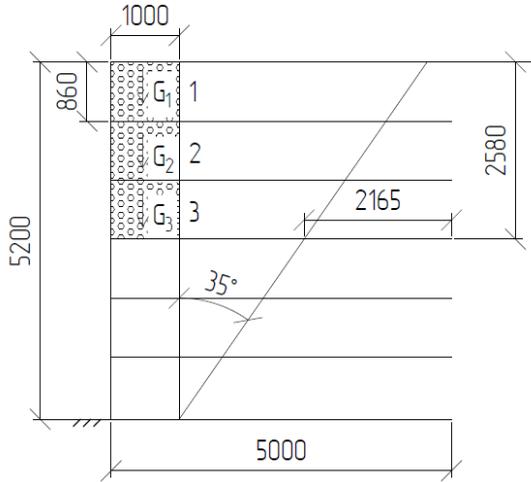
Схема расчета прочности армирующих панелей на разрыв
